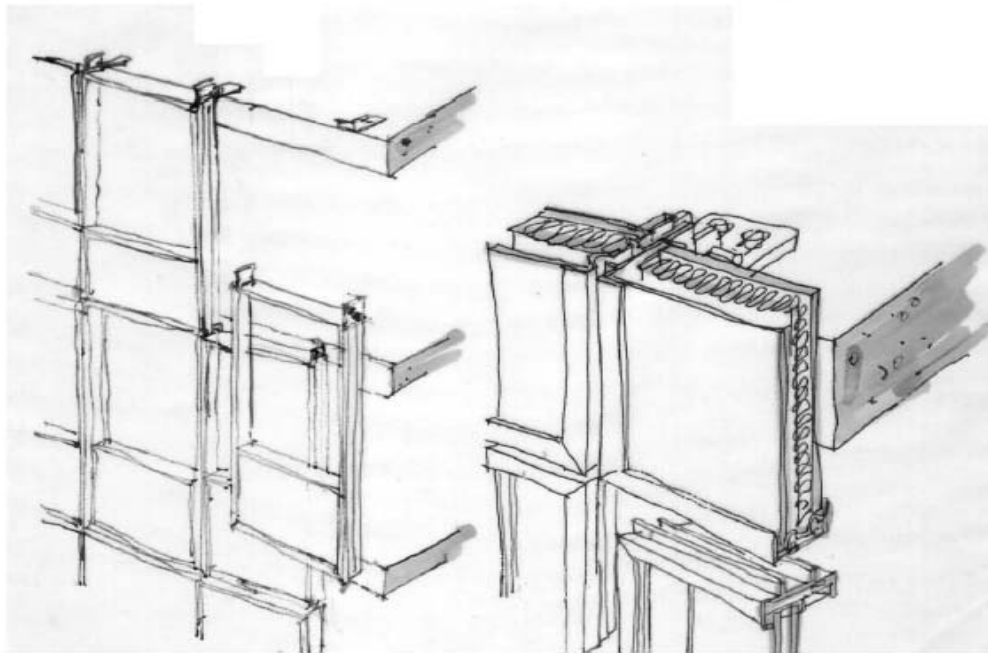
Imagen que muestra detalles de fachada ligera construida con el sistema modular.
